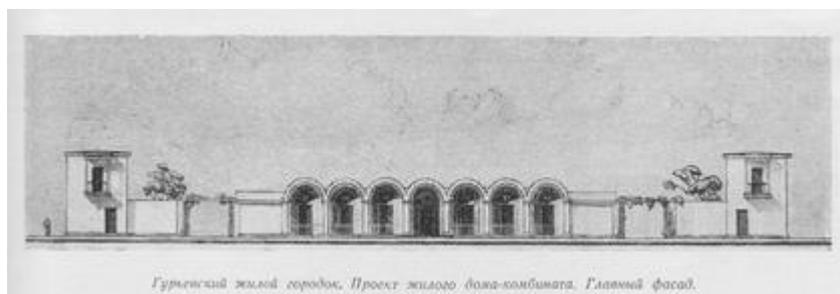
Проект жилого дома-комбината. Главный фасад
